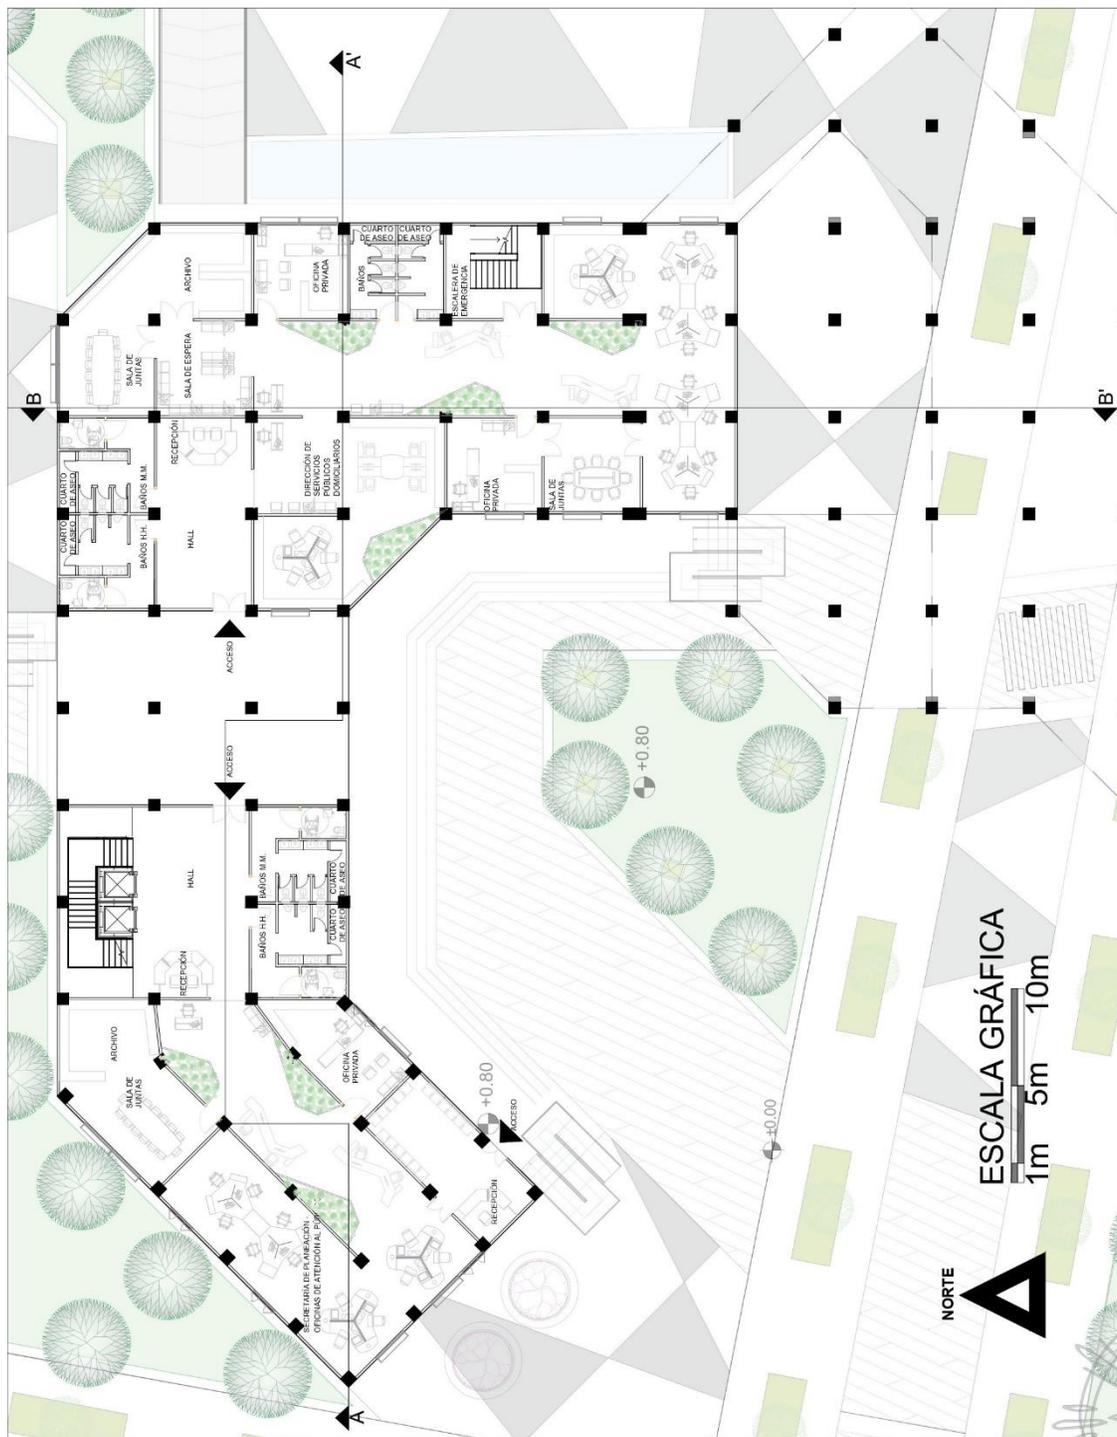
Planta nivel 1 Edificio Alcaldía
